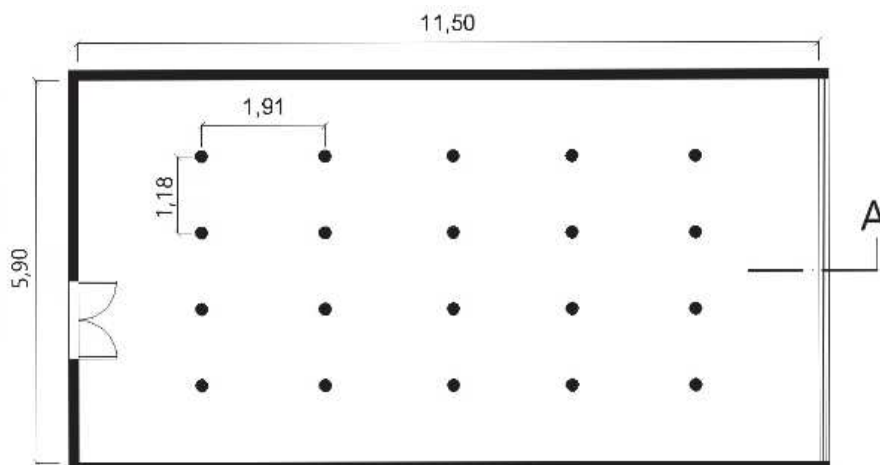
Planta baixa esquemática do ambiente analisado com a localização dos pontos de medição.
